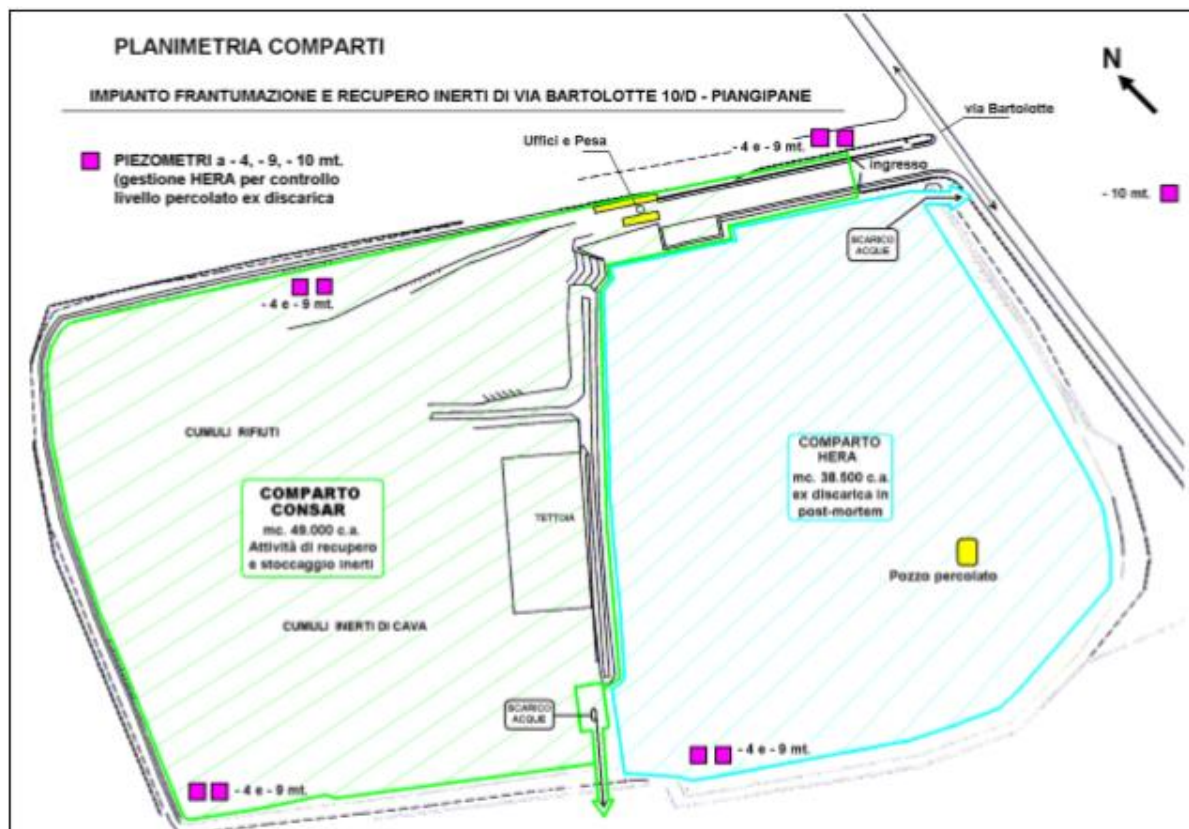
Planimetria con la suddivisione del sito in Comparti
